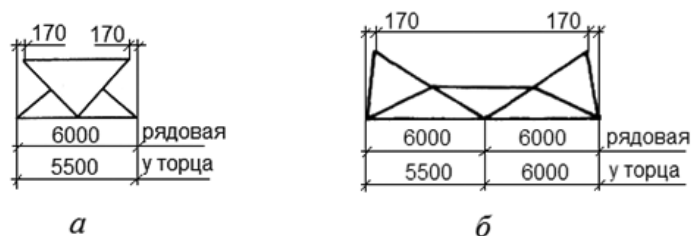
Схемы рядовой и торцевой вертикальных связей между стропильными фермами:
